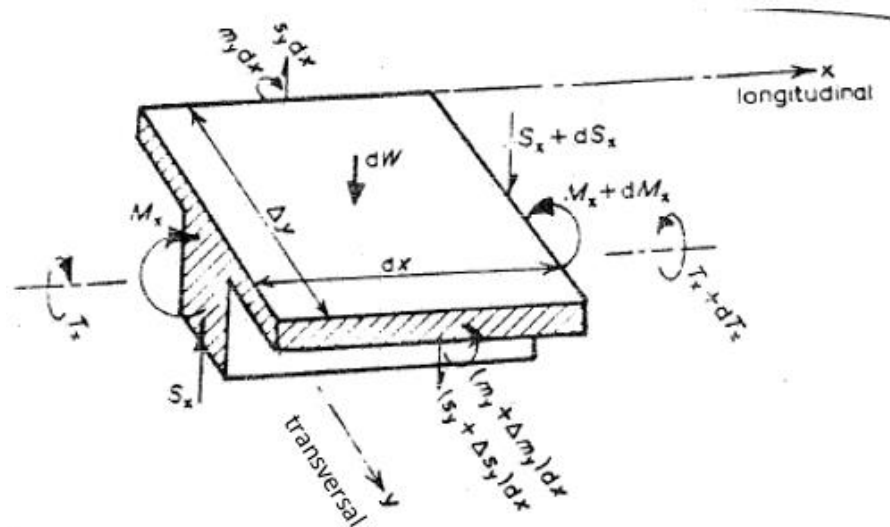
Elemento de tabuleiro em laje e vigas. Fonte: Adaptado de Hambly (1991)
